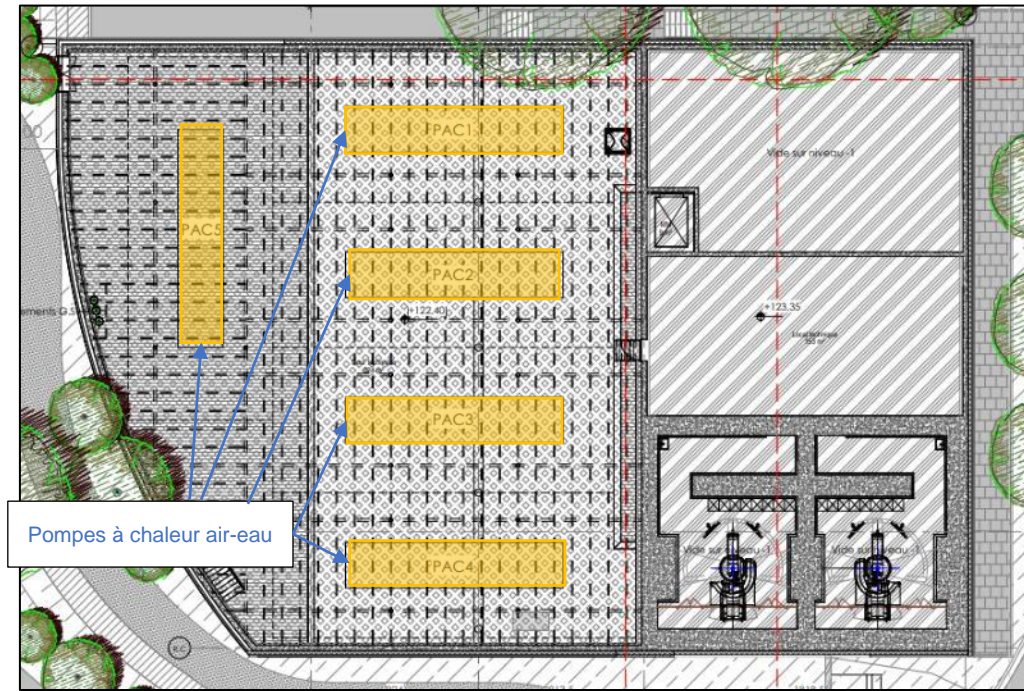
Positionnement des installations (Power house – niveau RDC)
